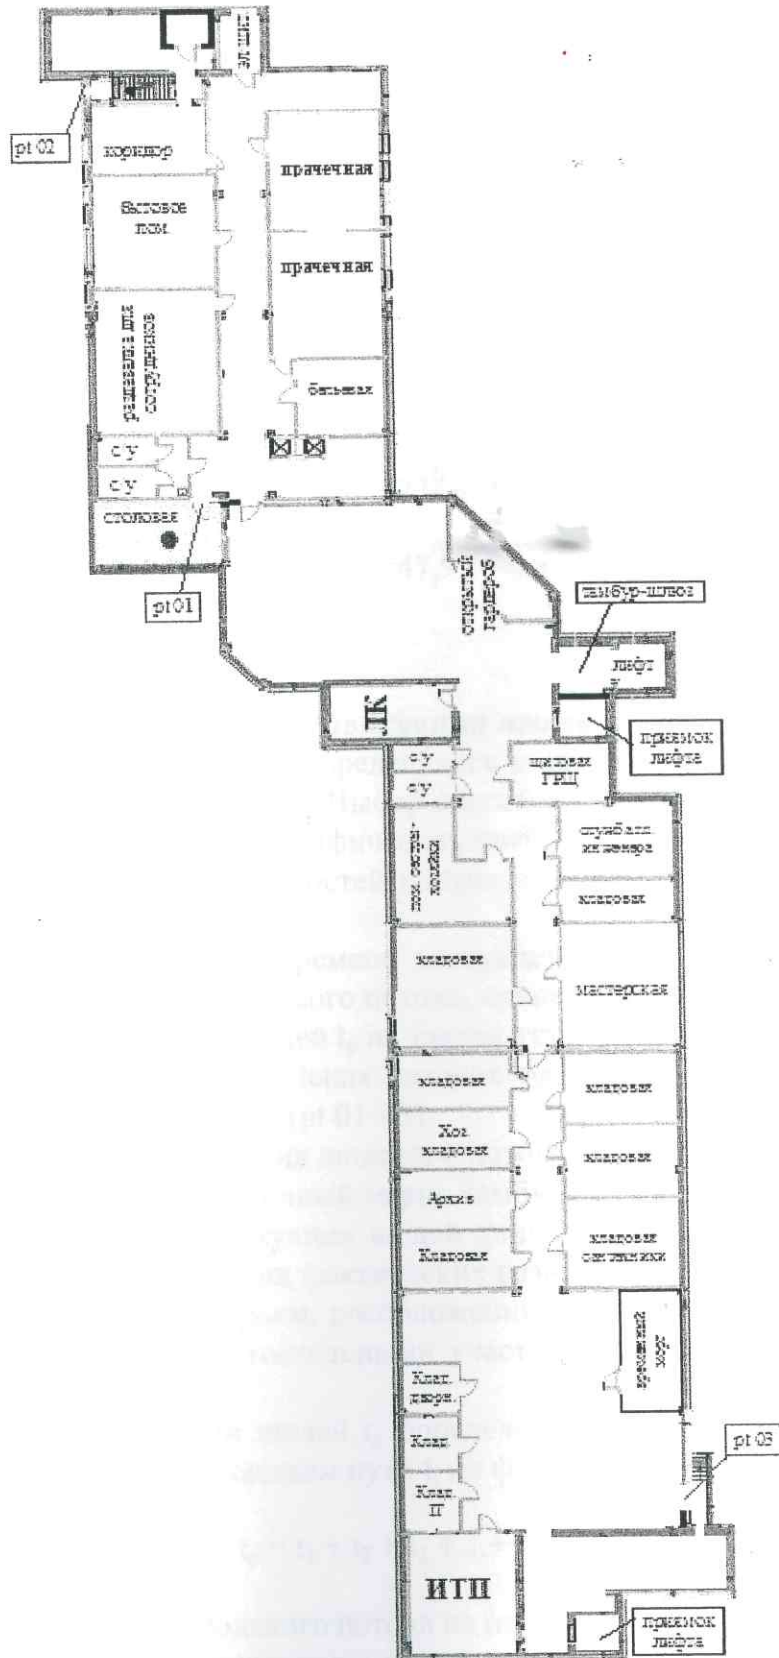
Расчетная схема помещения очага пожара и места расположения расчетных точек 01-03 для расчета динамики развития ОФП для сценария пожара П.
